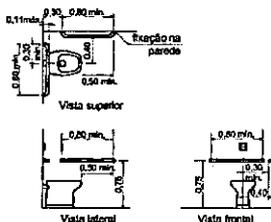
Bacia sanitária — Barras de apoio lateral e de fundo
